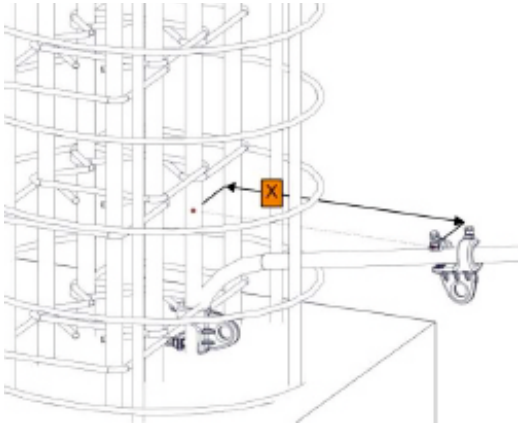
Installazione raccomandata del punto di ancoraggio AT187
